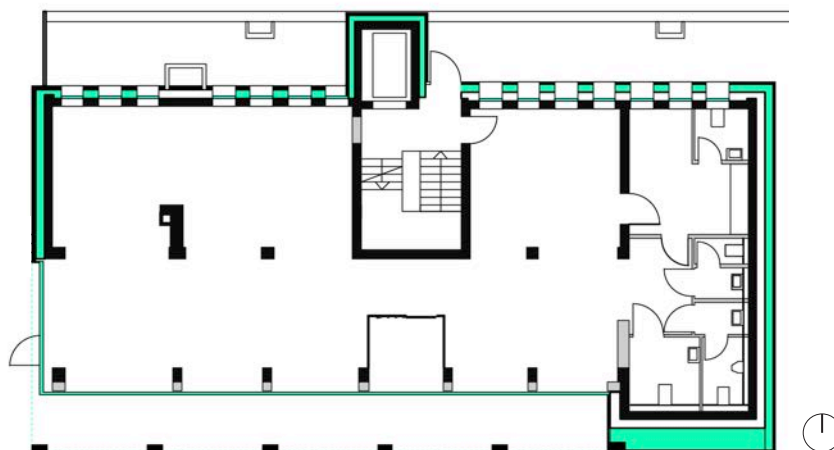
Wohnhochhaus Güterstraße 30. Floor plans (1:250)
